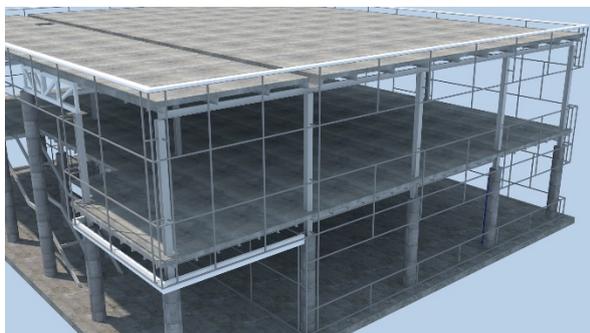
Animación realista de entramado metálico de fachada, obtenida del modelo virtual. En esta se observa la disposición de los perfiles metálicos que sustentan las placas de fachada, así como sus anclajes a la estructura del edificio. (Elaboración propia, Allplan 2015).
